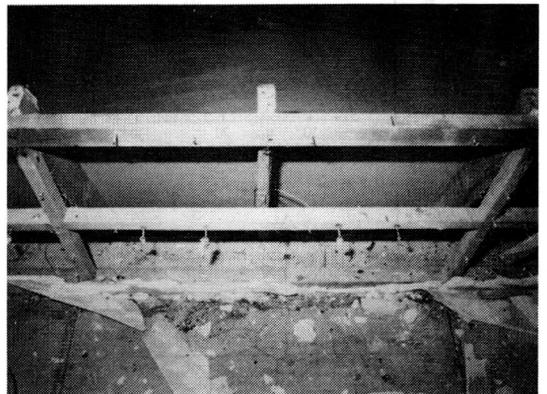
試験体記号 B (試験後の軒裏の軸組の状態)
